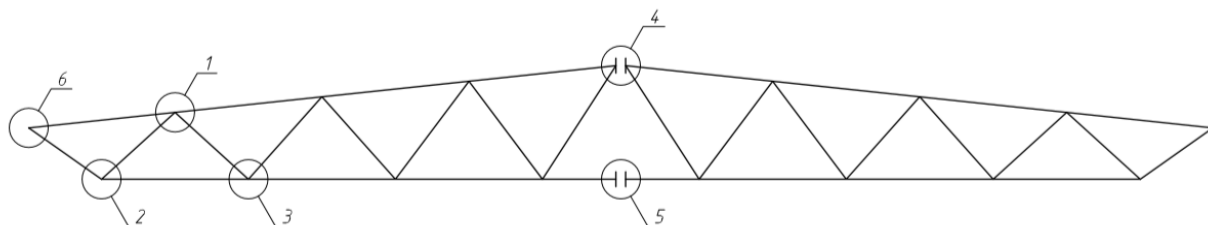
Схема расположения узлов к расчету и конструированию узлов фермы
